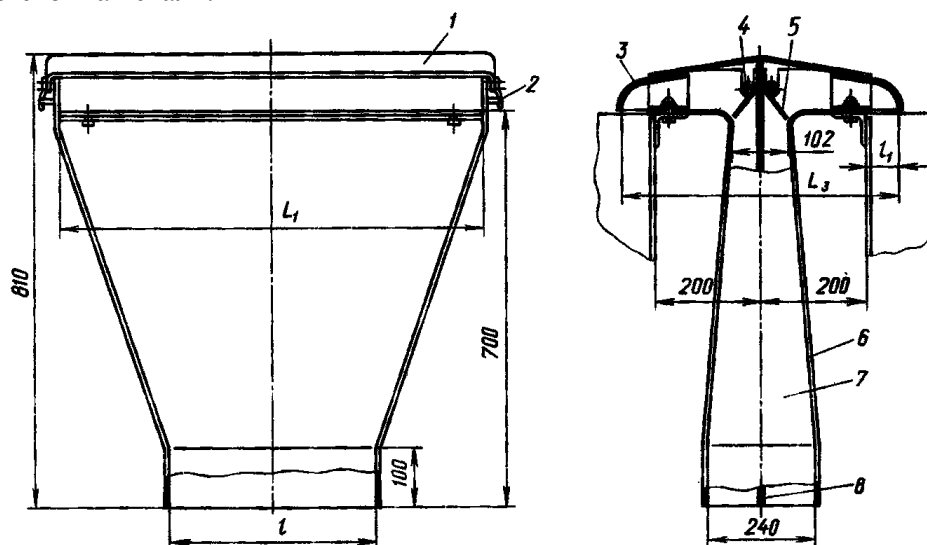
Двусторонний бортовой отсос с горизонтальной щелью всасывания: 1 — съемная крышка; 2 — скоба; 3 — козырек; 4 — ось; 5 — дроссельная заслонка; 6,7 — стенки; 8 — разделительная стенка
